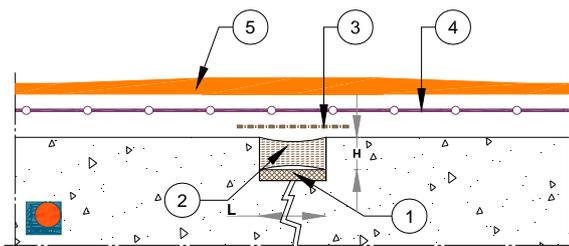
Fissures actives > 2 mm traitées à façon de joint (Étude de structure préalable)
